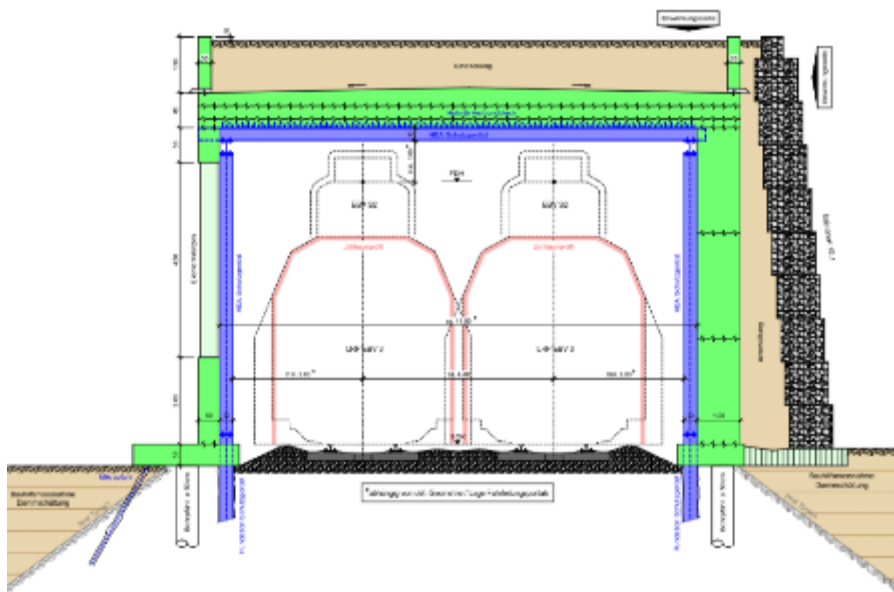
Querschnitt Stahlbetongalerie Bahn (aus Bausteinbericht "Schutzbauten Bahn – Galerie- & Netzlösung", 19. Dezember 2019)
